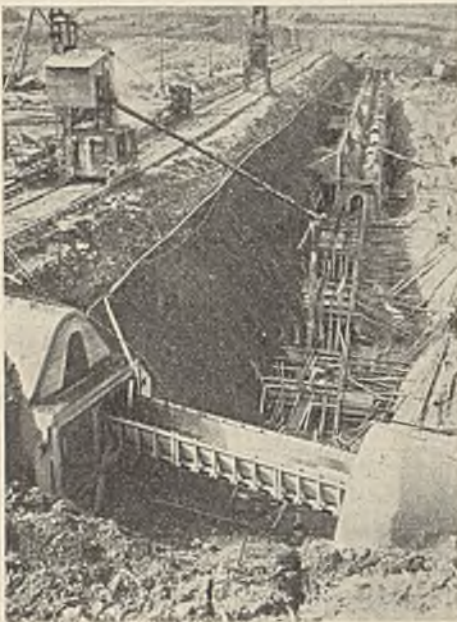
Betonieren des Stahlwandsockels im Talgrunde. Im Vordergrund die Kreuzung mit dem Grundablaß.
